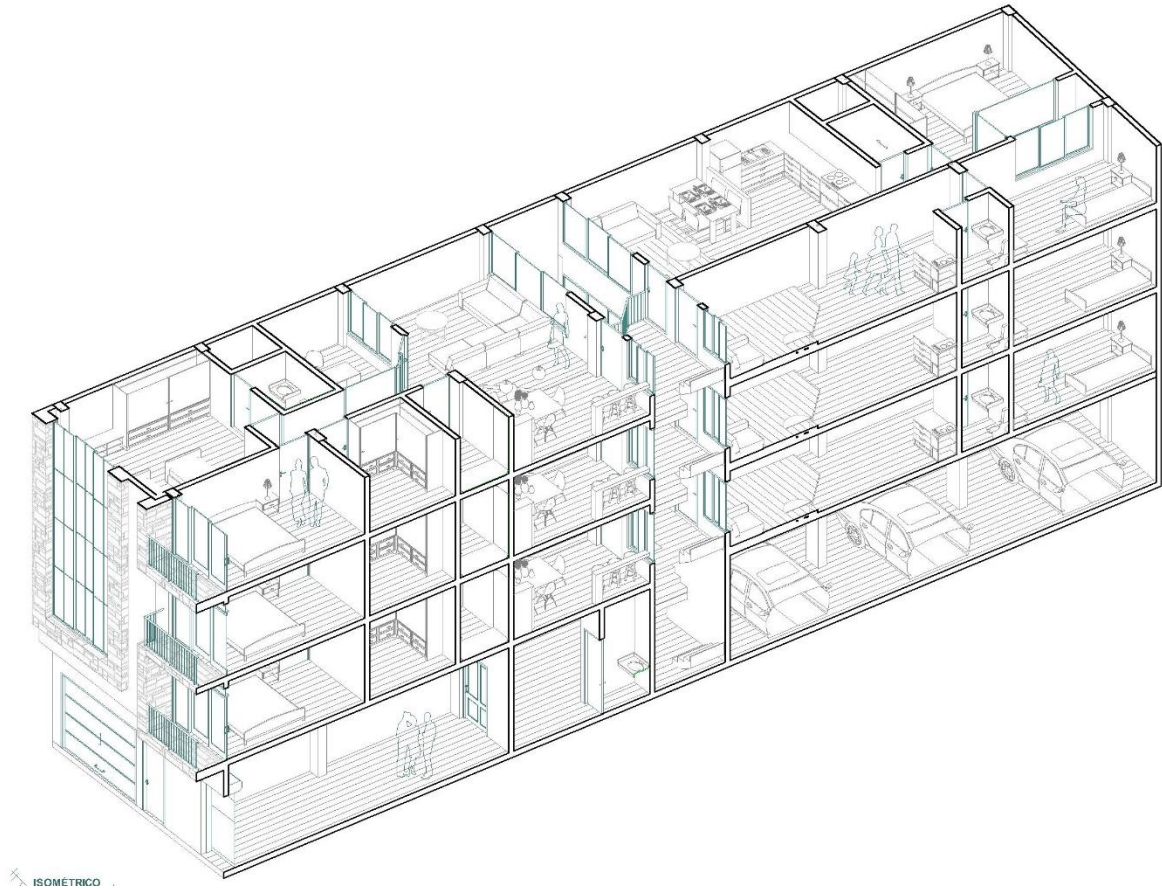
Vista isométrica y corte de la fachada a diseñar.
